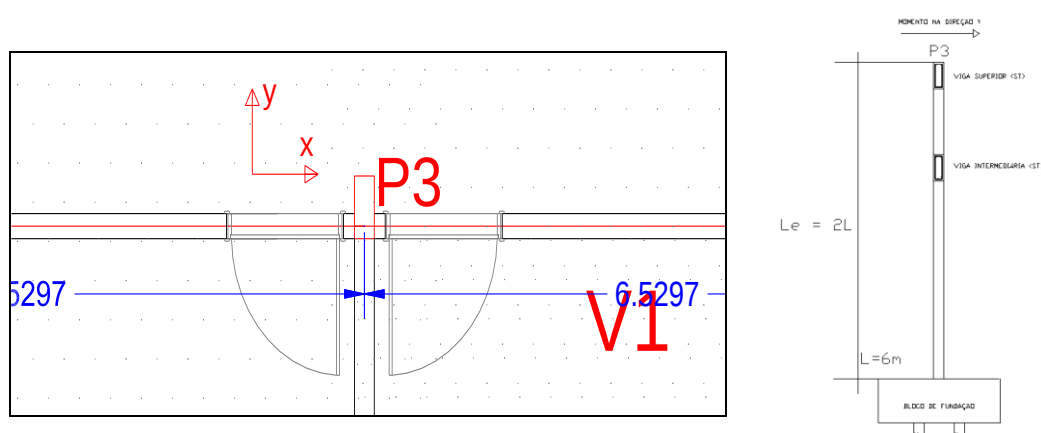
Croqui, em planta e corte, de pilar que possui elevado comprimento de flambagem, no caso $2L$, na direção global Y (pilar 3, estrutura 1).
